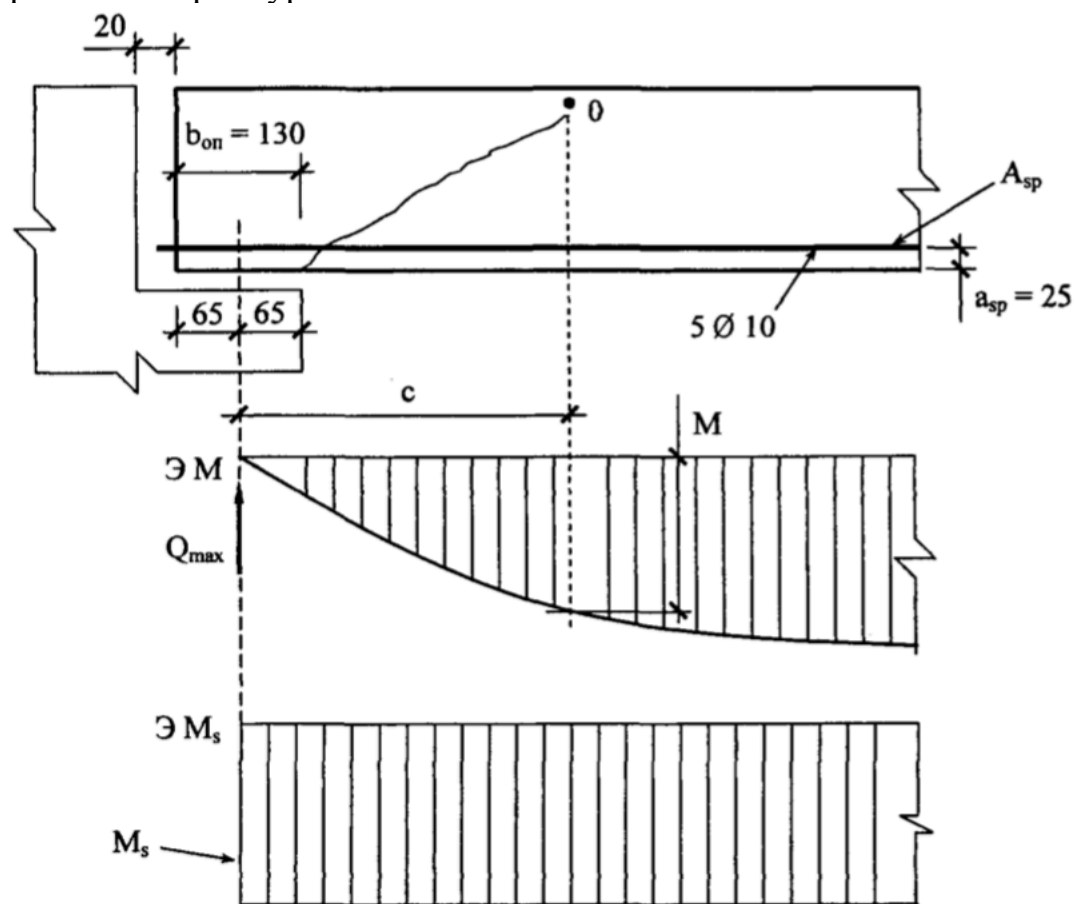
Расчетная схема узла опирания балки на ригель и эпюры моментов
